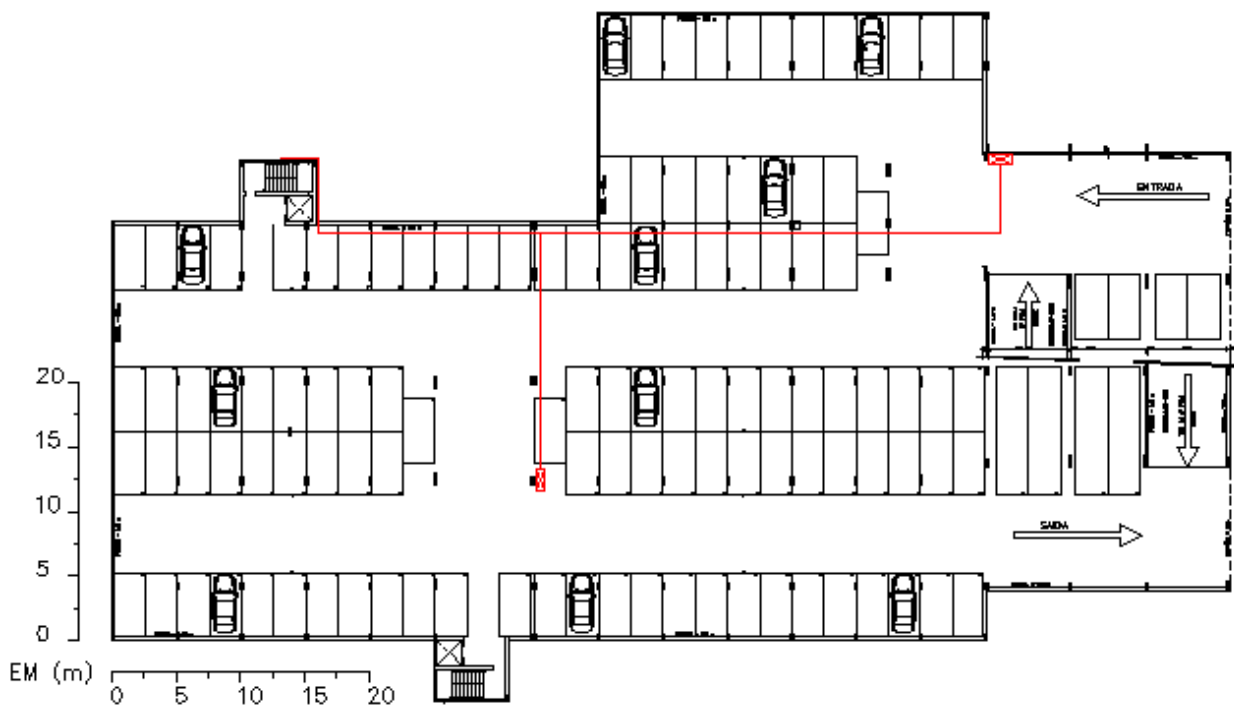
Rede de Hidrantes no Pavimento Térreo
